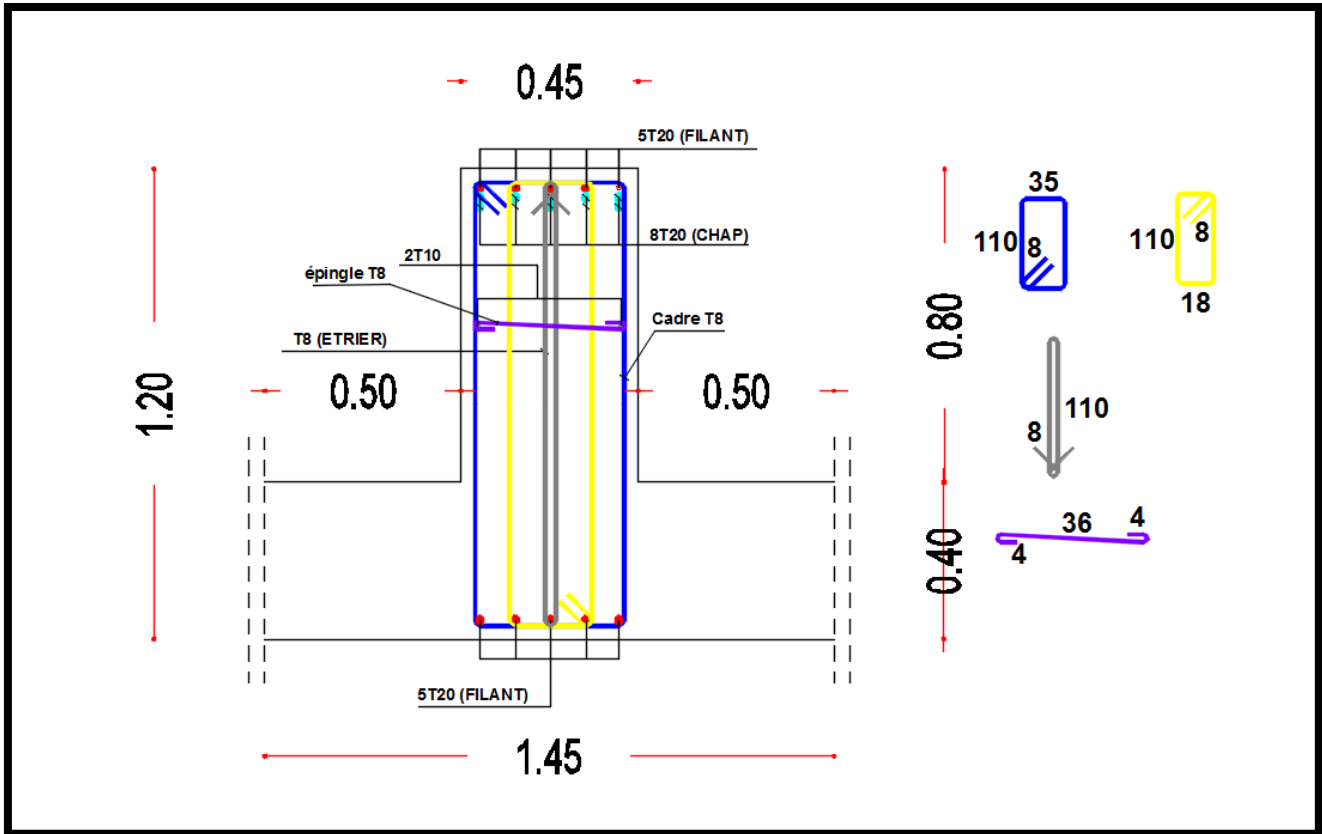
schéma de ferrailage du la poutre principale en travée
